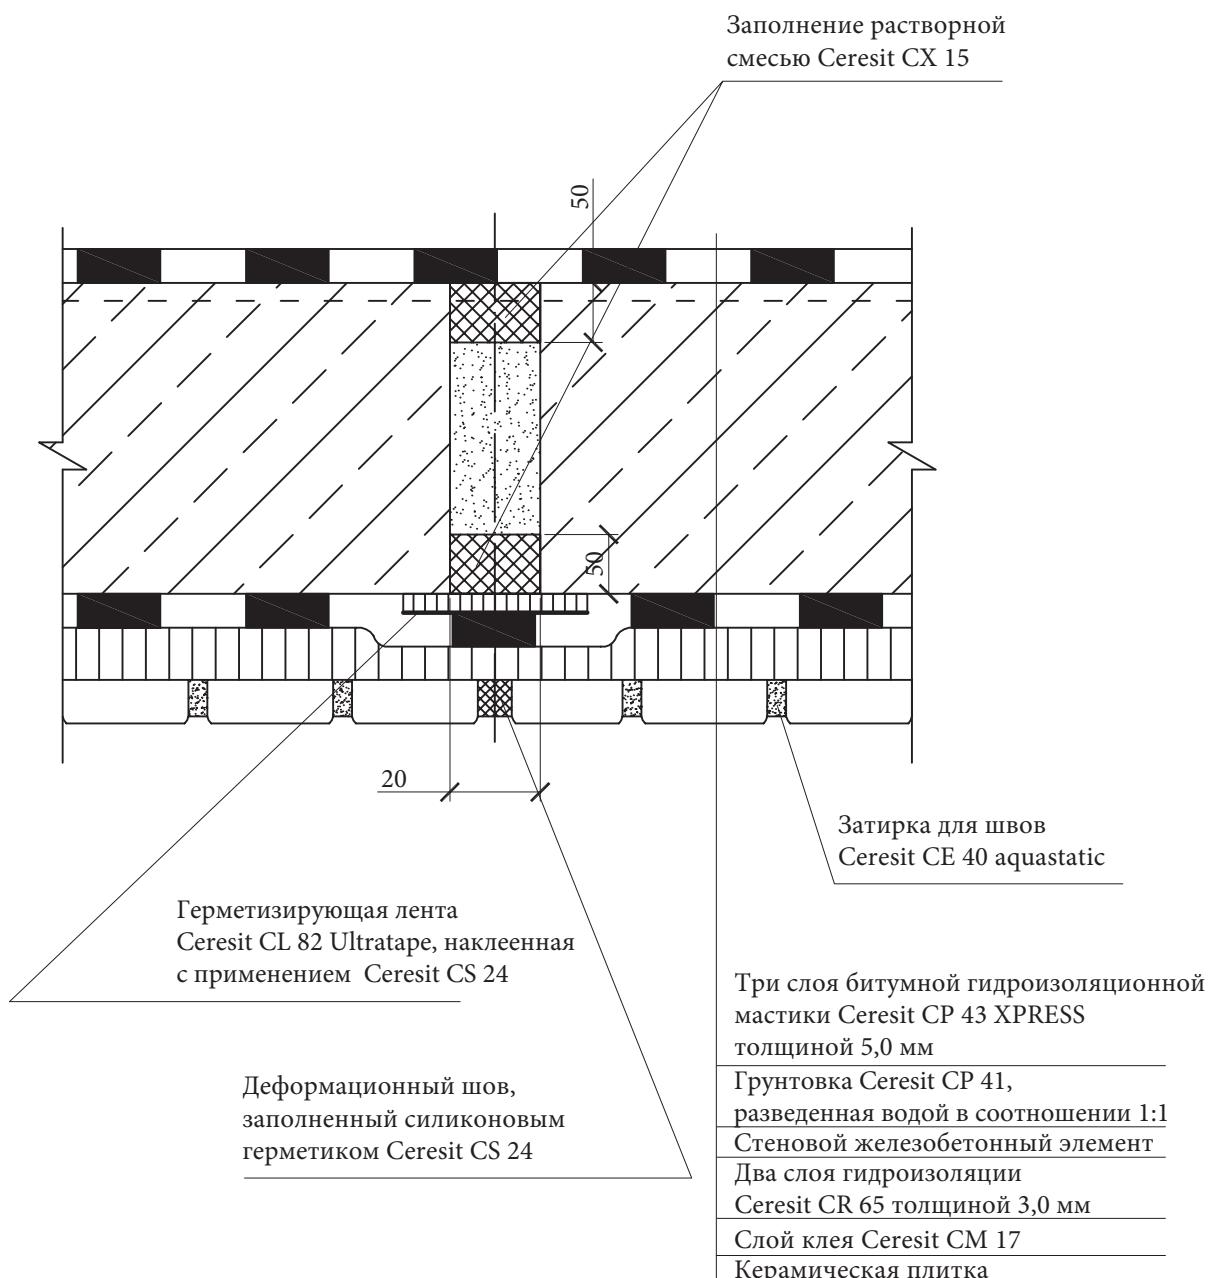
Конструкция герметизации вертикальных стыков между сборными стеновыми элементами железобетонных резервуаров для питьевой воды с облицовкой
